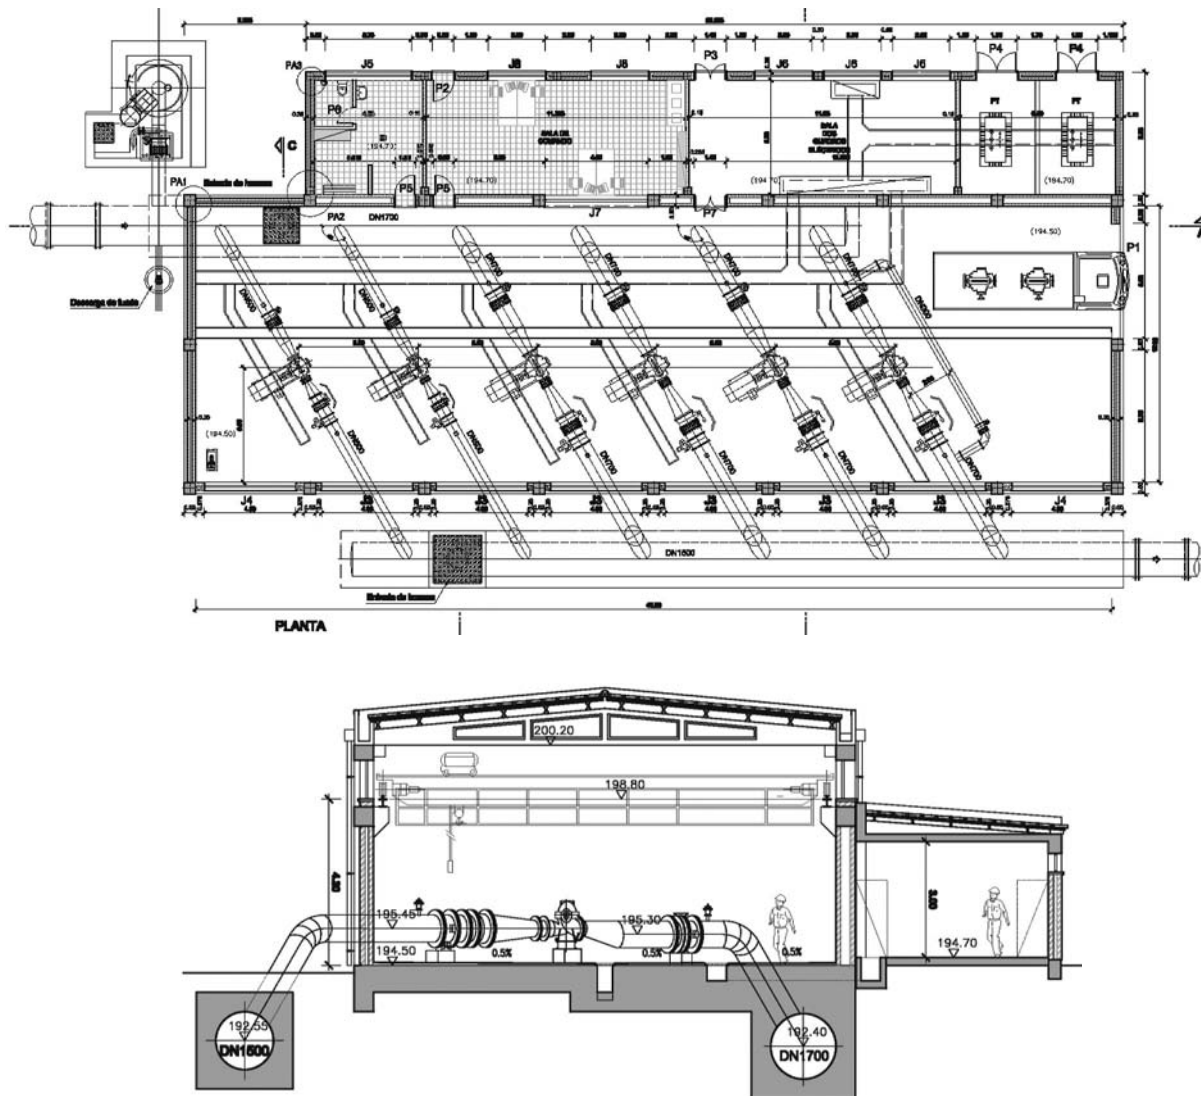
Estação Elevatória de Beja. Planta e Corte
